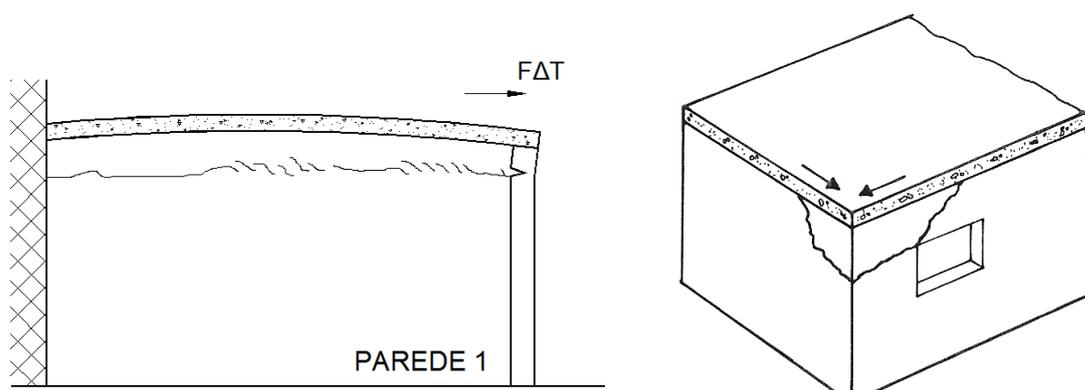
Configuração típica de fissuras causadas por movimentação térmica (VALLE, 2008)
